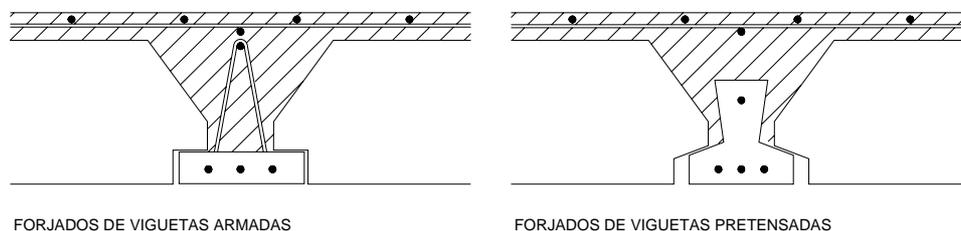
Tipos usuales de forjados de viguetas
